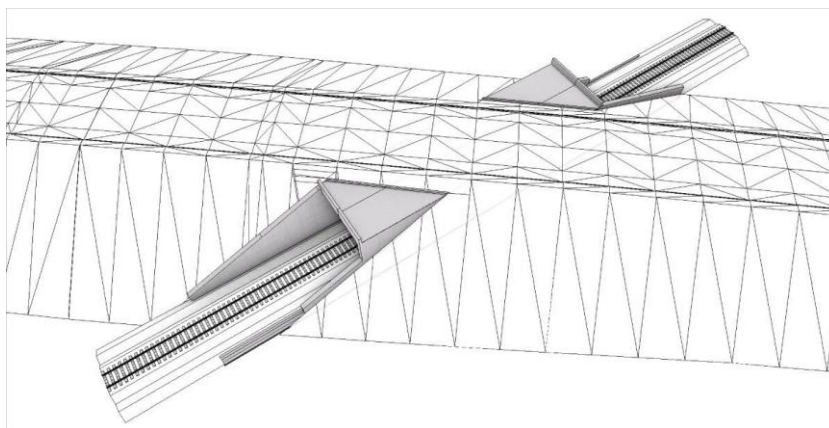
Modelo 3D de uma passagem inferior e o terreno circundante no Allplan Bridge.
